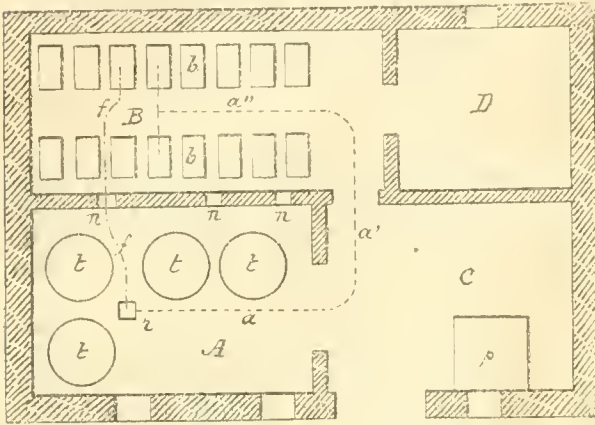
Plan d'un chai dans le Sud-Ouest.
